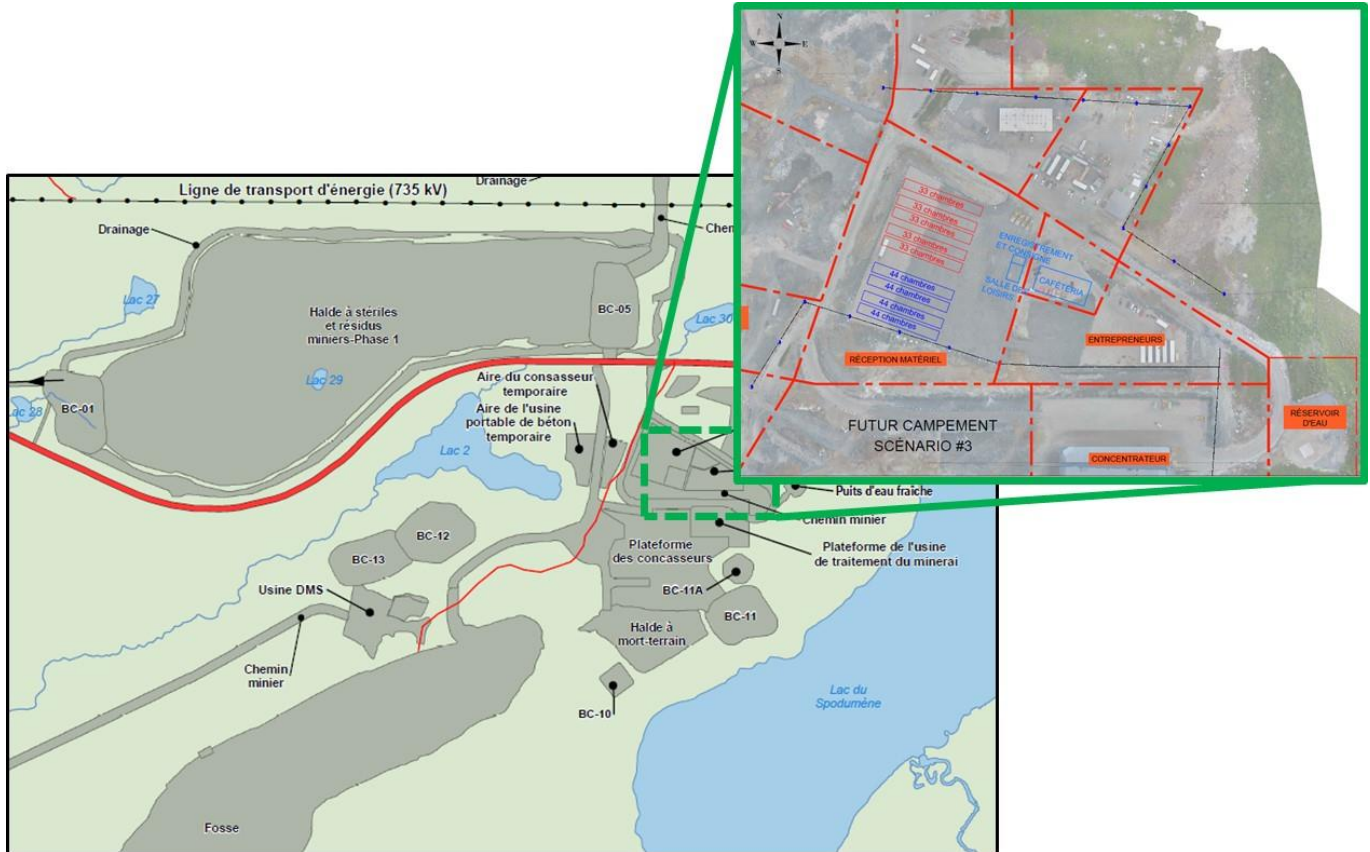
Localisation projetée pour le camp de construction au site minier Whabouchi
